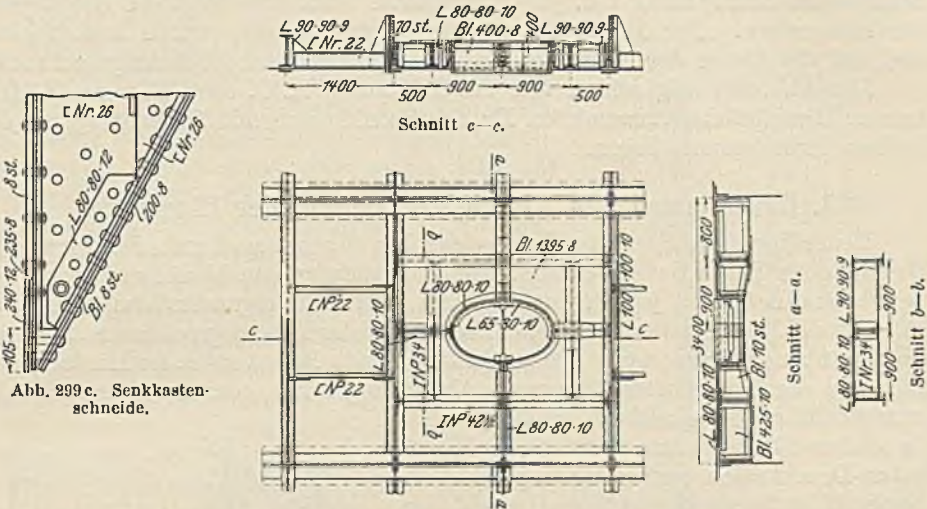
d, Ausbildung des Durchganges eines Schachtrohres durch die Senkkastendecke.
